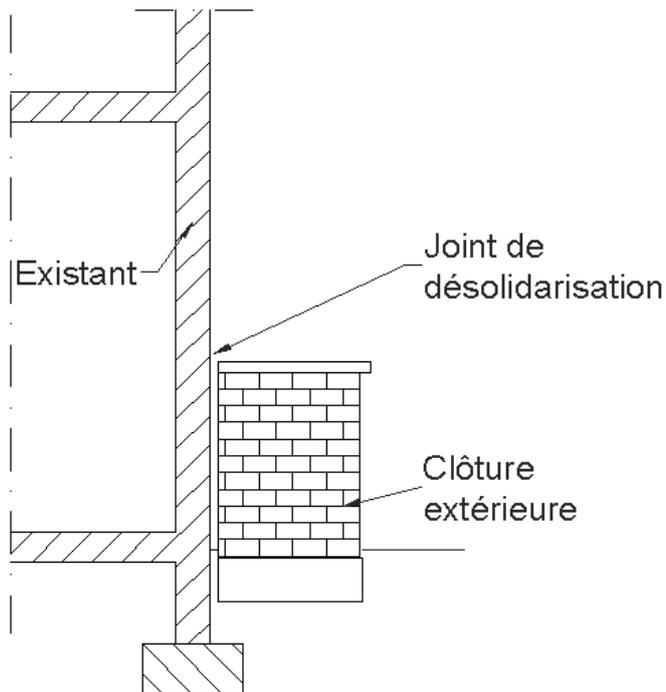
recommandation pour les fondations d'ouvrages secondaires
